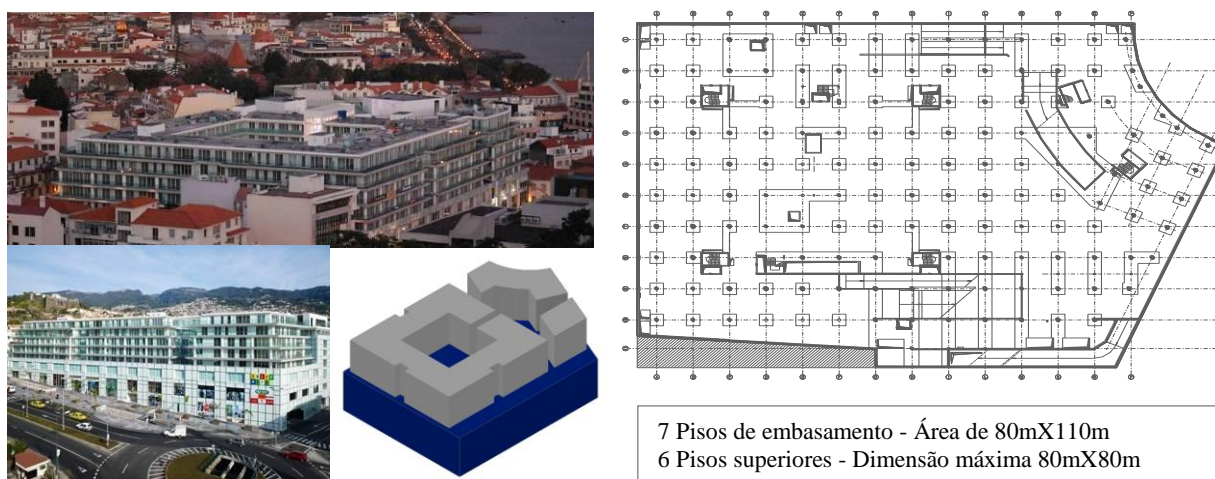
Funchal Centrum, Dolce Vita Funchal – Edifício de grande porte sem juntas estruturais [8]
